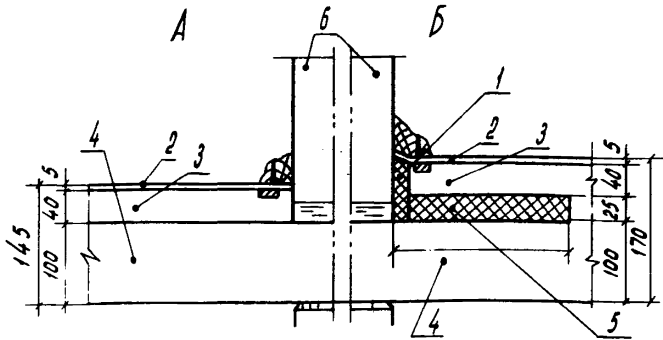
Звукоизоляция перекрытий в домах серии I-464 д:
